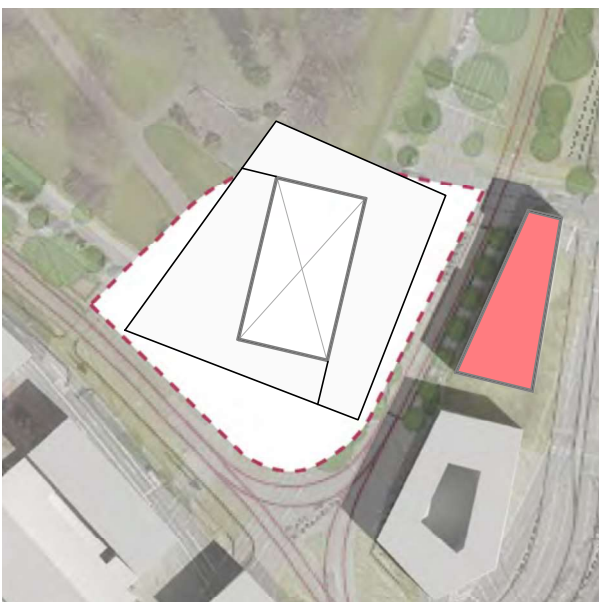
Grundriss OG4 Bahnhofsquartier V2
